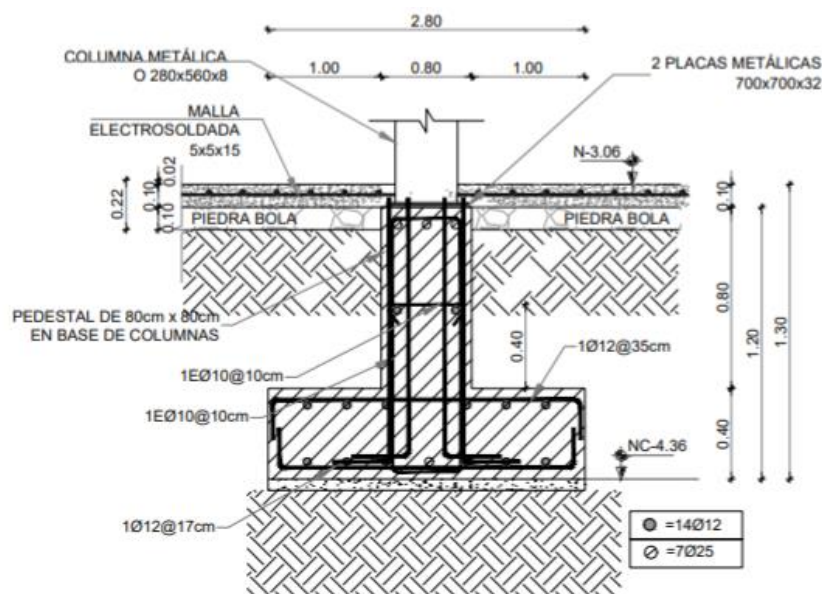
Sección de viga de cimentación y contrapiso. Elaboración propia, 2019.
